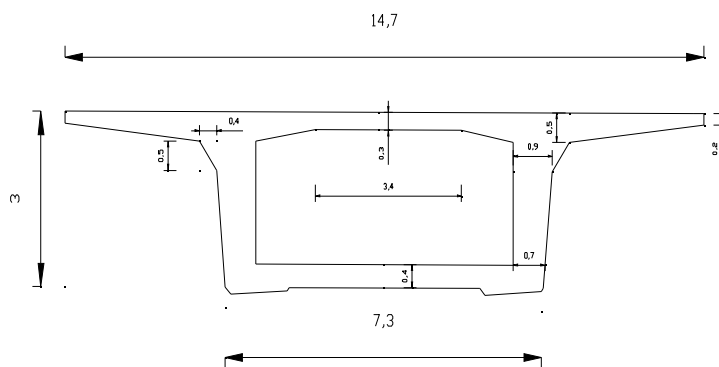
Corte transversal do tabuleiro sobre os pilares P5 e P9.
